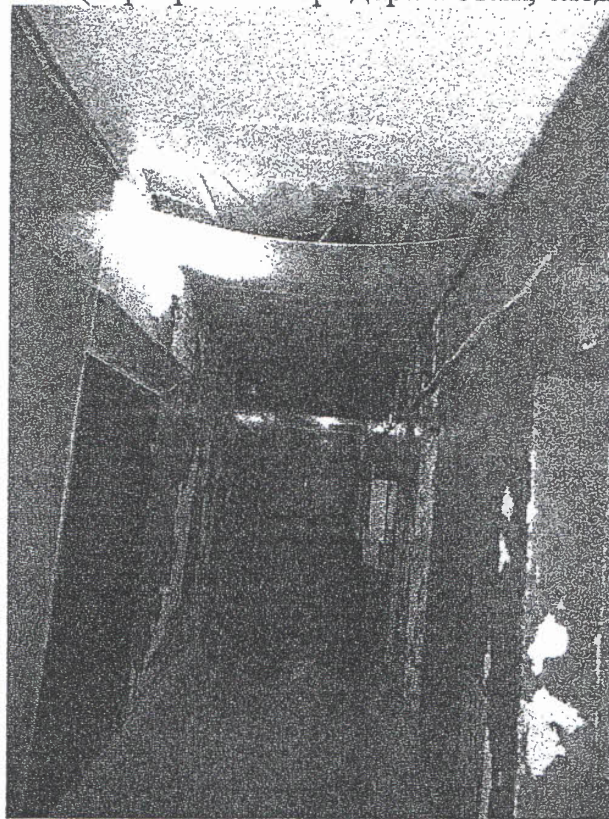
(перекрытия коридора 1 этаж, следы протечек, грибка)
